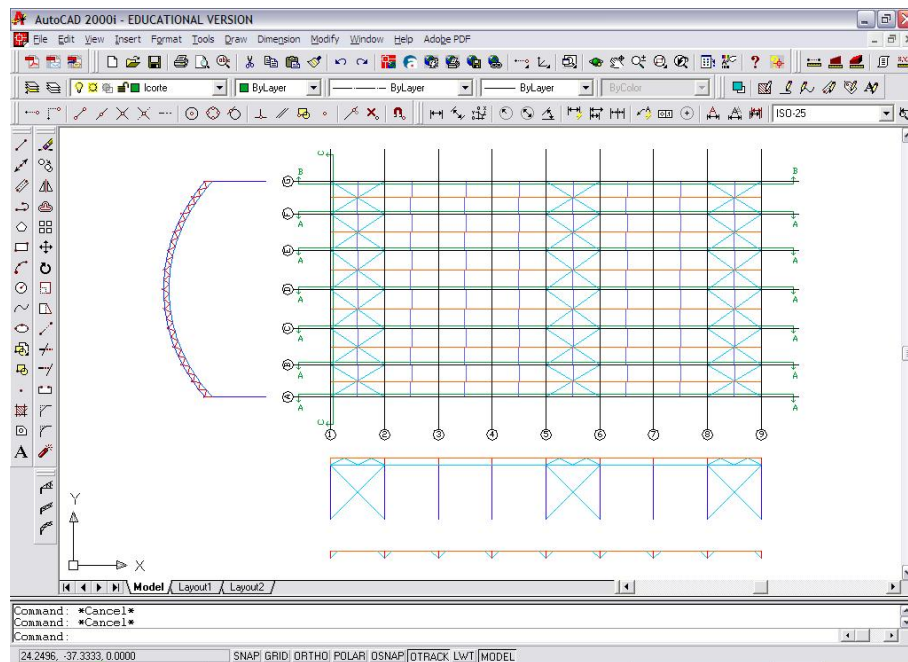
Geometria do arco treliçado e planta com os contraventamentos gerados automaticamente.
